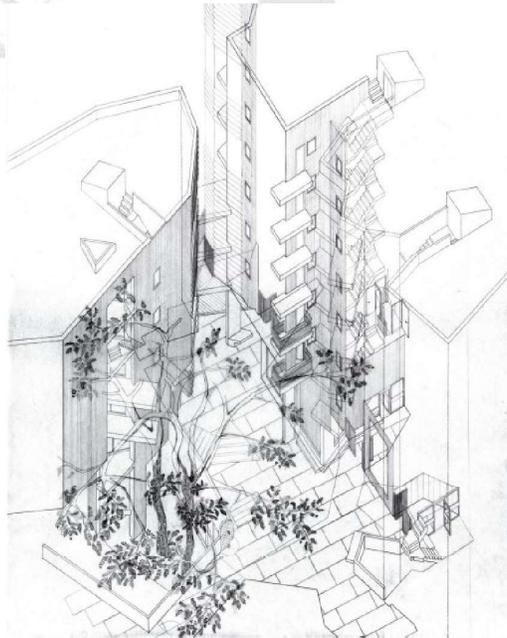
Patio central como articulador de acceso a los bloques de vivienda.
